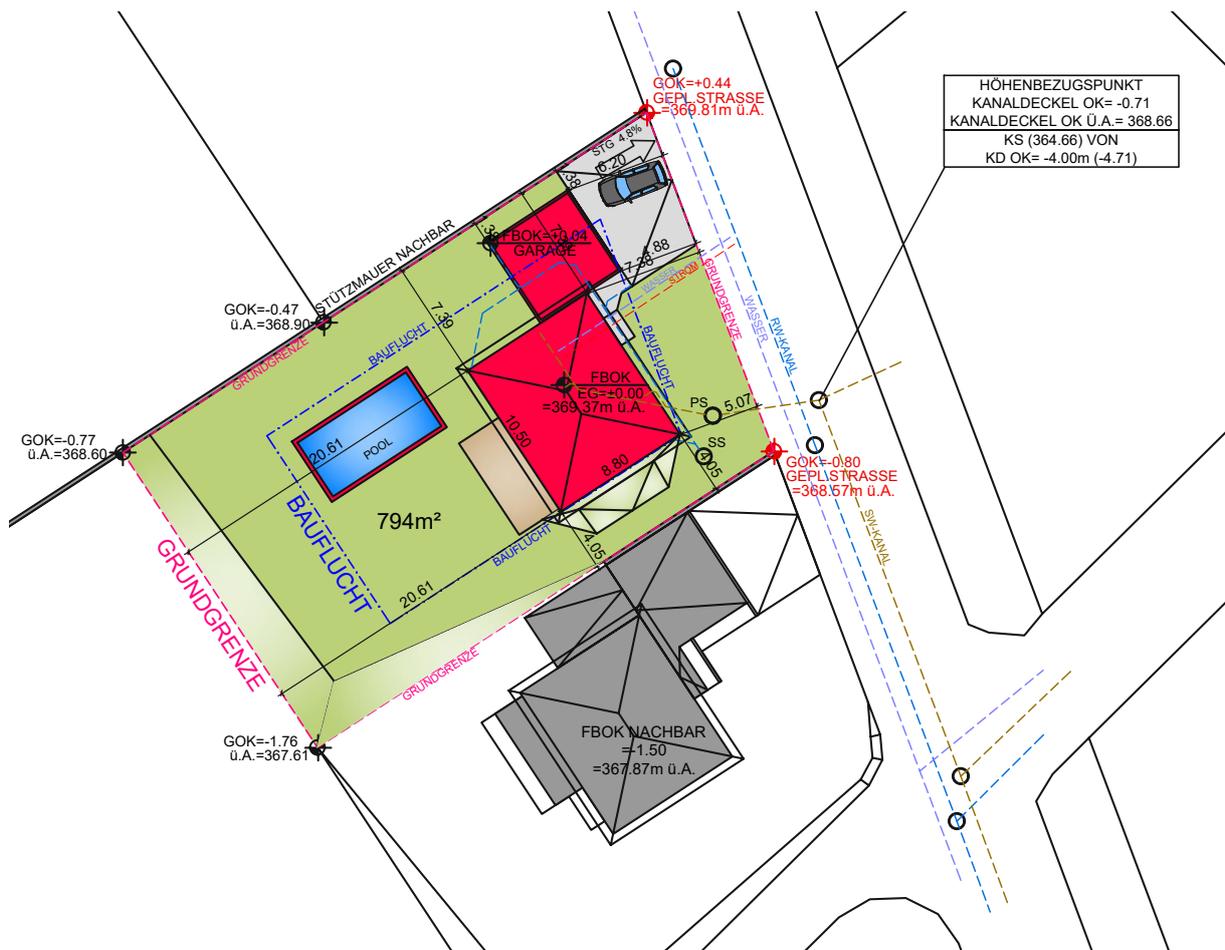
Lageplan des Einfamilienhauses [39]
